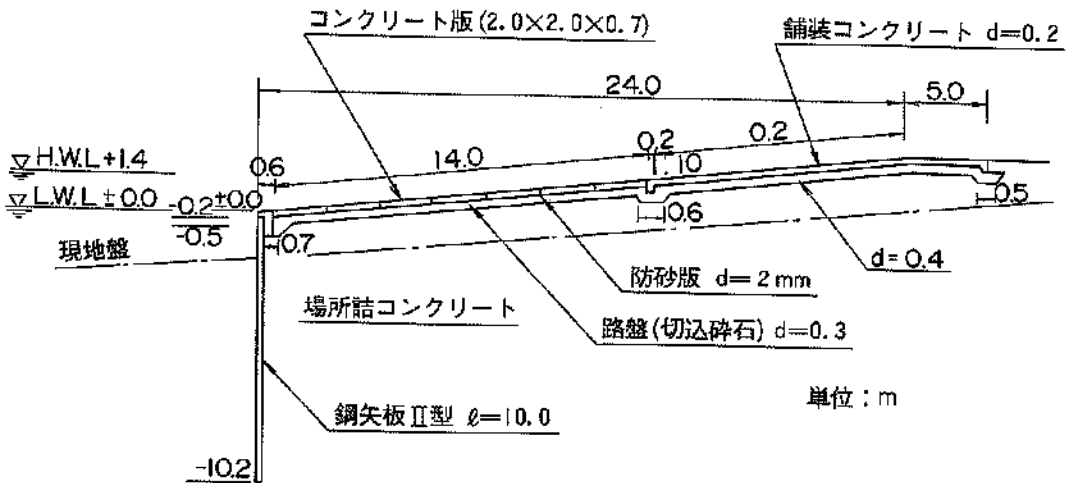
標準断面図 (㊸第1洞内船揚場)
